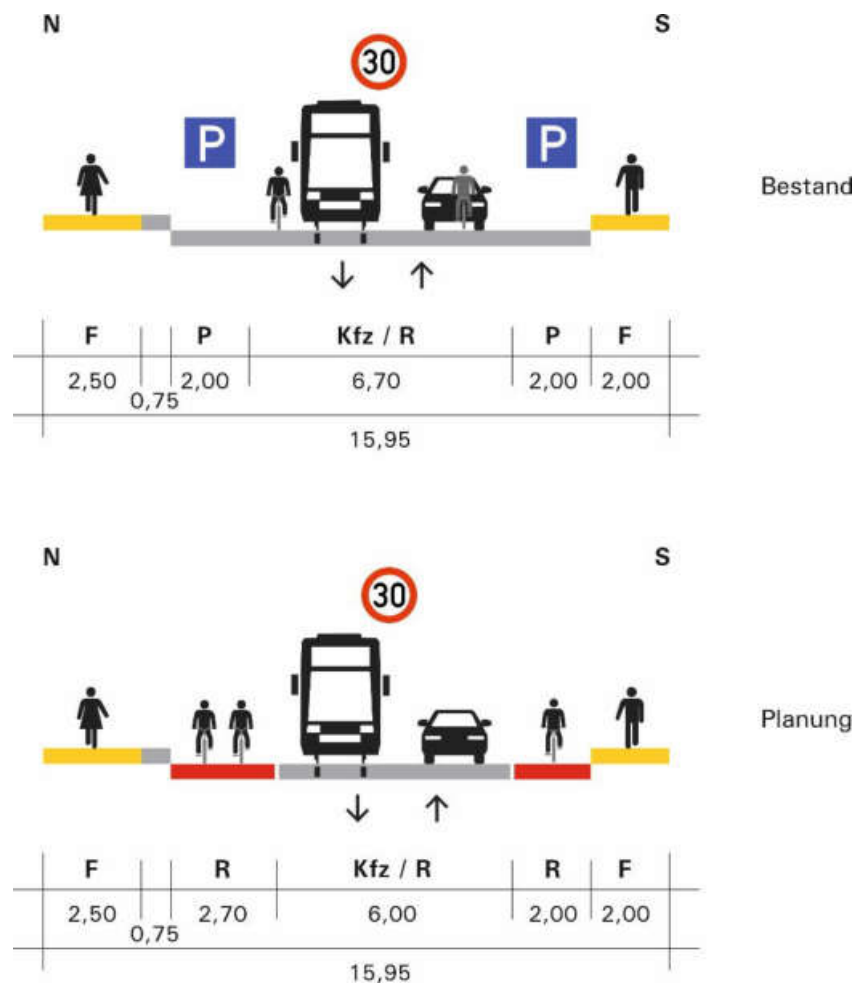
Querschnitt WH-06-a3 (Geschwister-Scholl-Straße)
